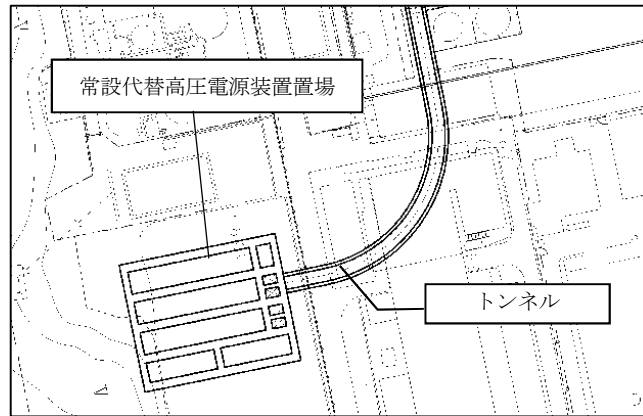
(1) 常設代替高圧電源装置置場とトンネルの平面配置図
